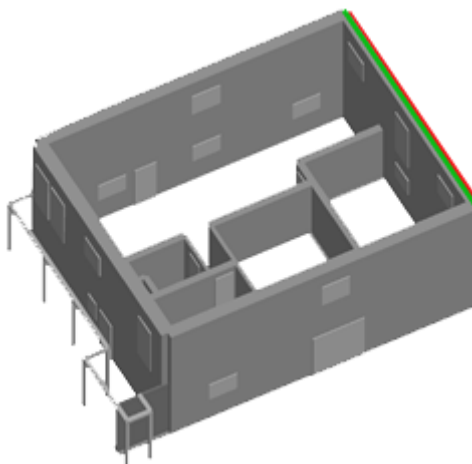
Esquema de introdução de tirantes ao nível do pavimento do sótão e execução de reboco armado numa face da fachada principal
